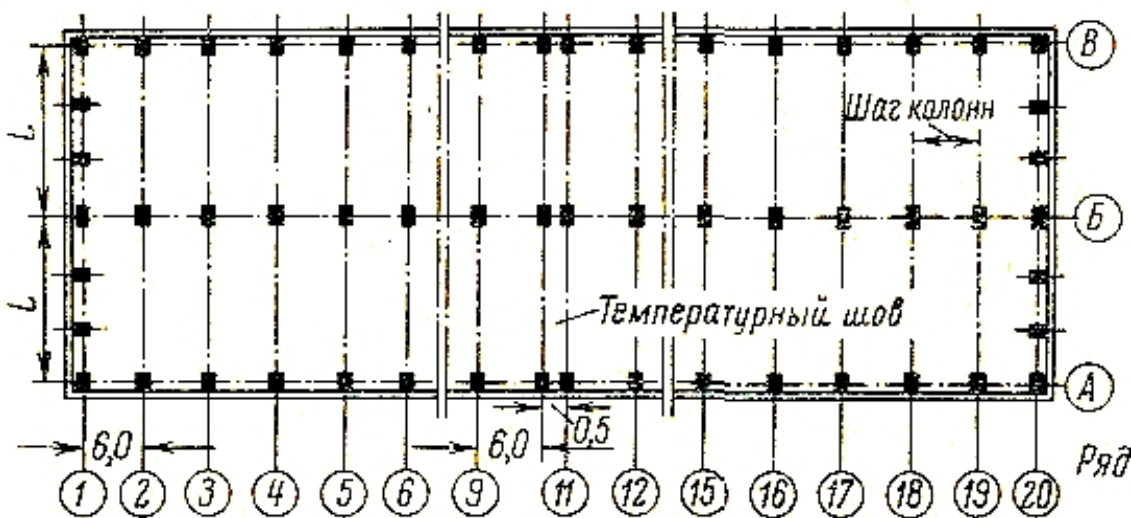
Разбивка рядов и поперечных осей колонн на строительных чертежах
